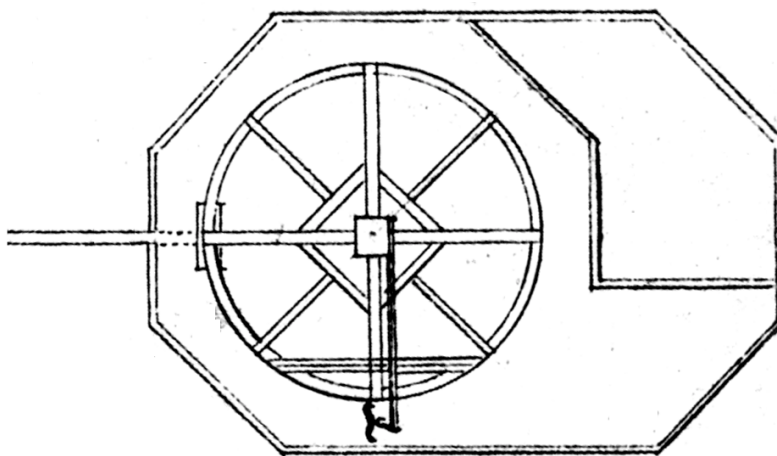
Grundriß einer Roßmühle mit Stall und Holzrad. Unten das Geschirr, in das die Pferde gelegt werden und an dem sie ziehend das Rad im Kreise drehen. Die Drehbewegung des großen Holzrades wird, wie auf der linken Bildseite zu sehen ist, durch ein Zahnrad auf die Welle übertragen, die unter der Lafebene der Pferde hindurch zur Arbeitsmaschine führt und diese antreibt.
